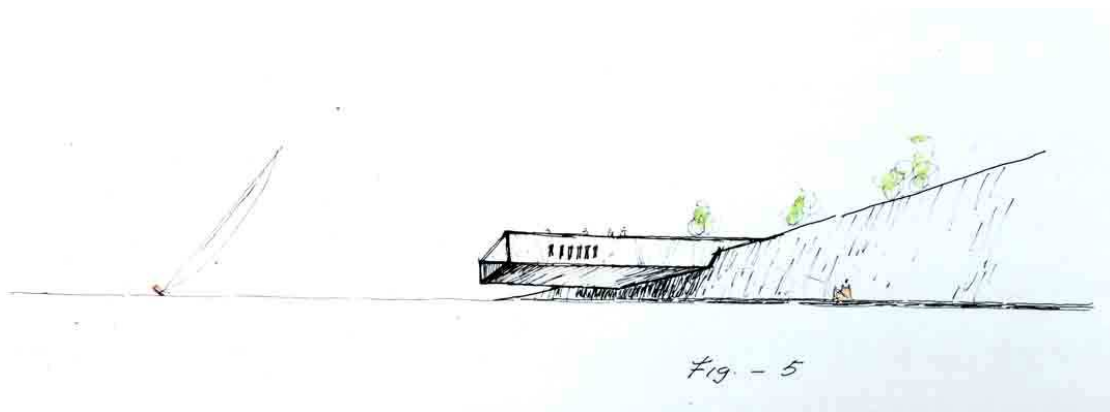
Croqui do Conjunto (Desenhos de Amaro Machado, Acervo do Autor)
